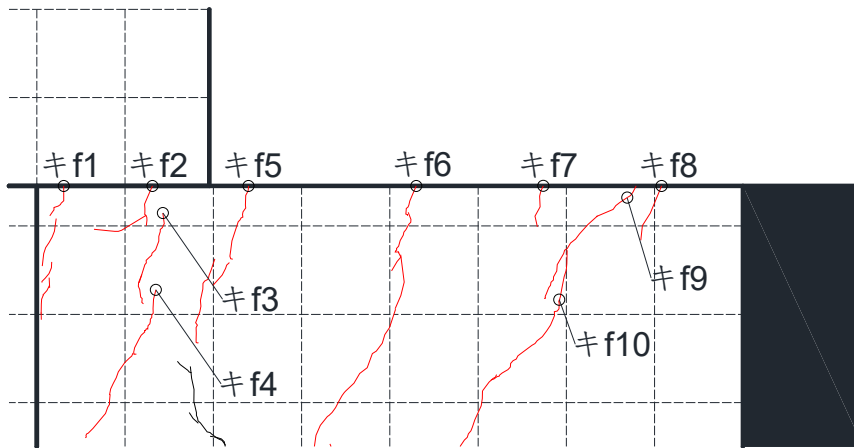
2. 3-89 基礎梁ひび割れ幅測定位置 (試験体 DR-3 -7.0 サイクル 観測面)
